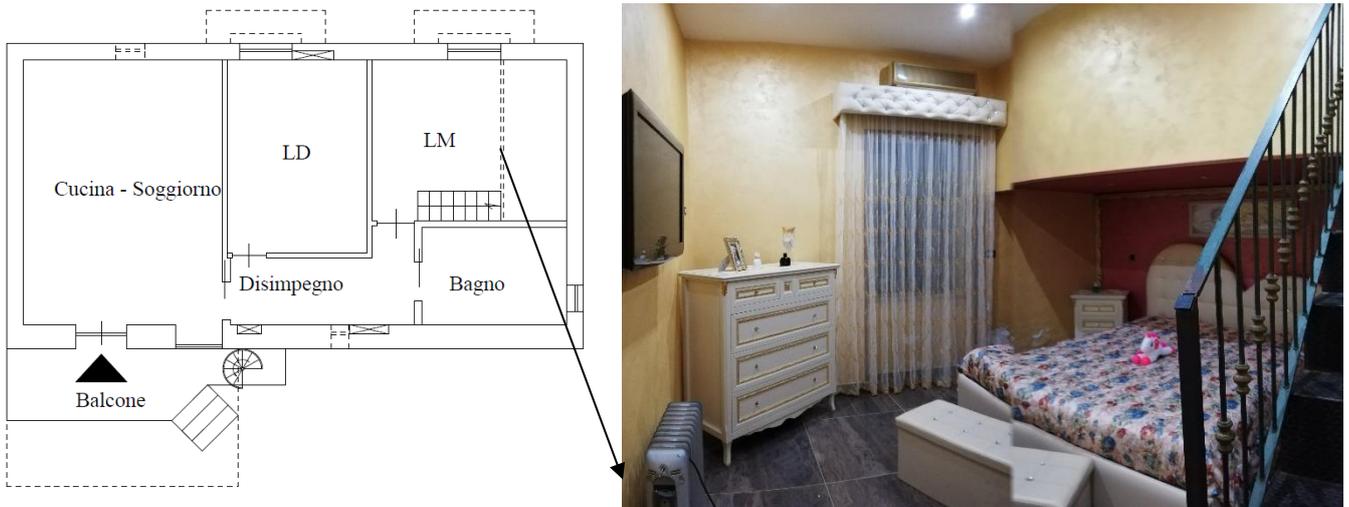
Individuazione fotografica degli interni del bene oggetto di pignoramento.
